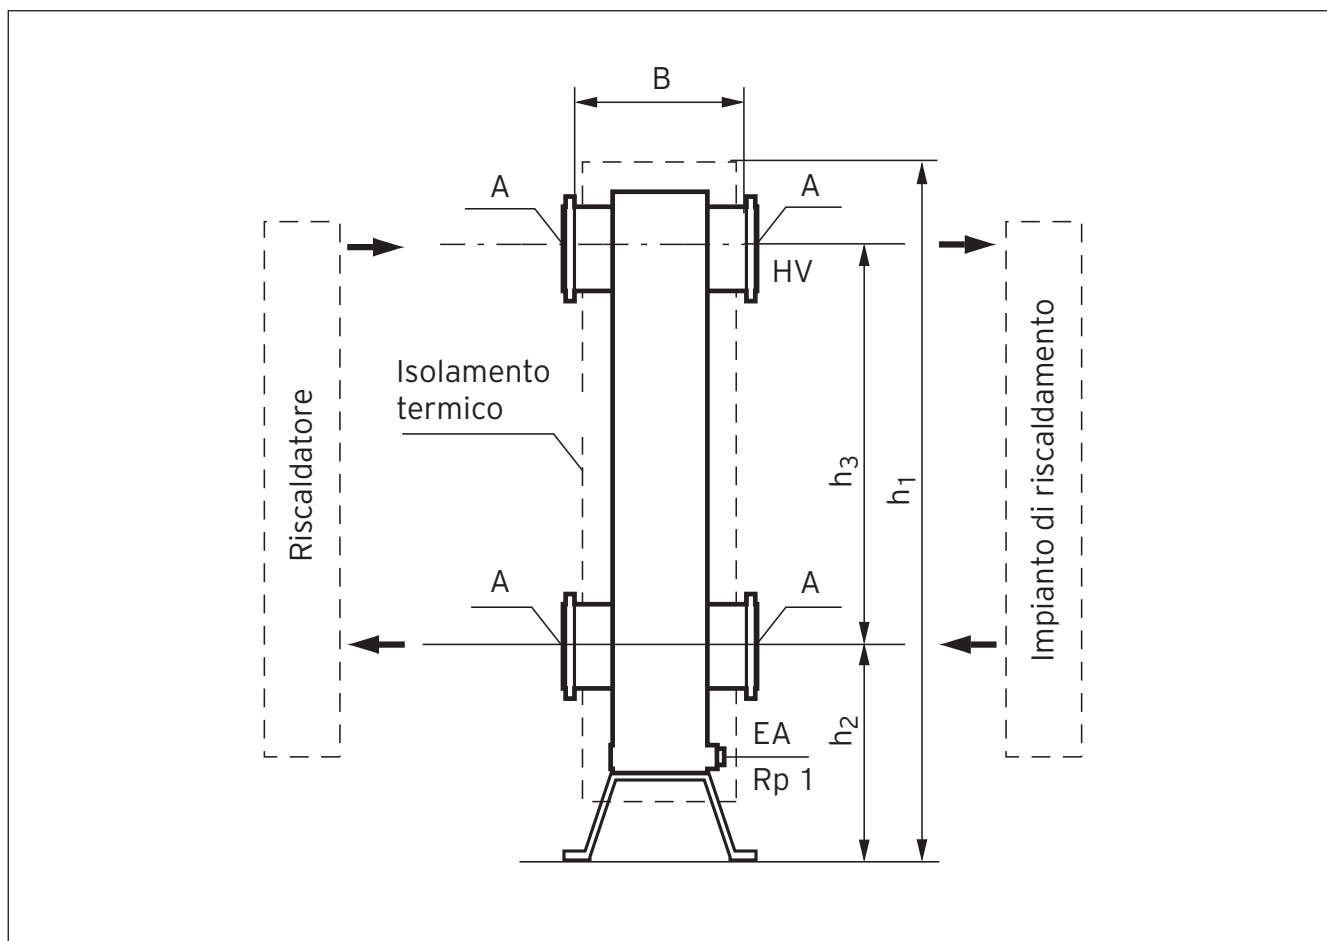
Disegno quotato: Equilibratore idraulico WH 160 e WH 280
